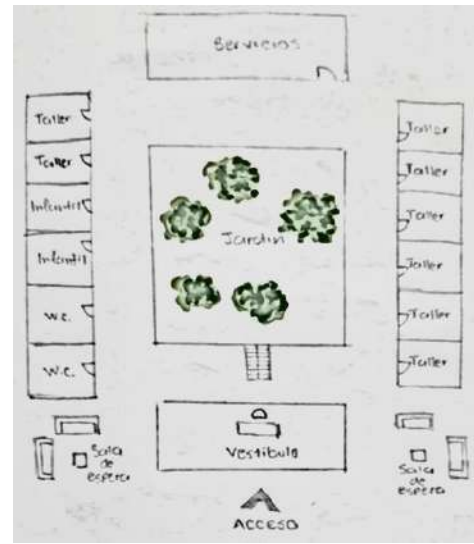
Boceto de planta arquitectónica, propuesta 2. Fuente propia.
